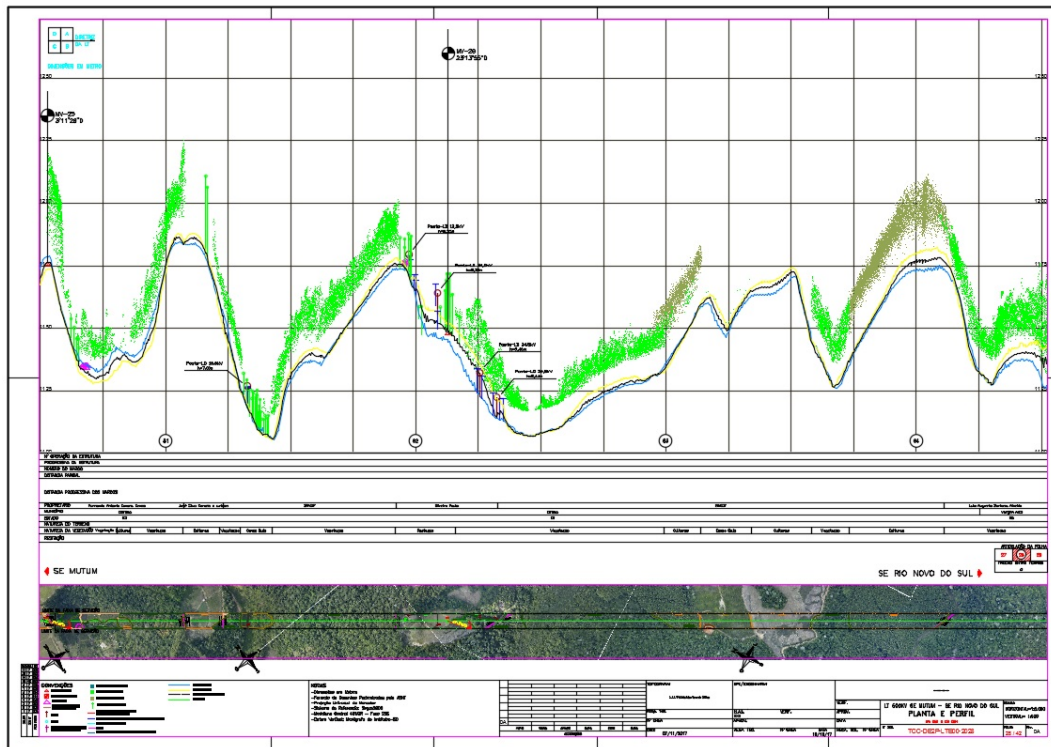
Modelo de Perfilamento a laser, em Planta&Perfil
